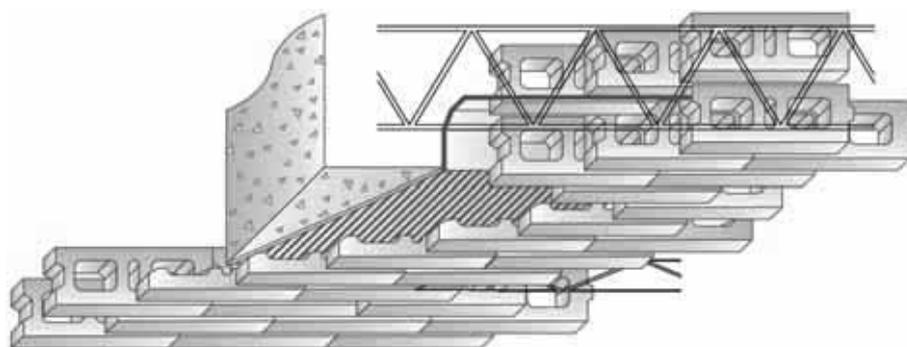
Muro capuchino de fábrica armada, atando las dos hojas de un peto de cubierta.
